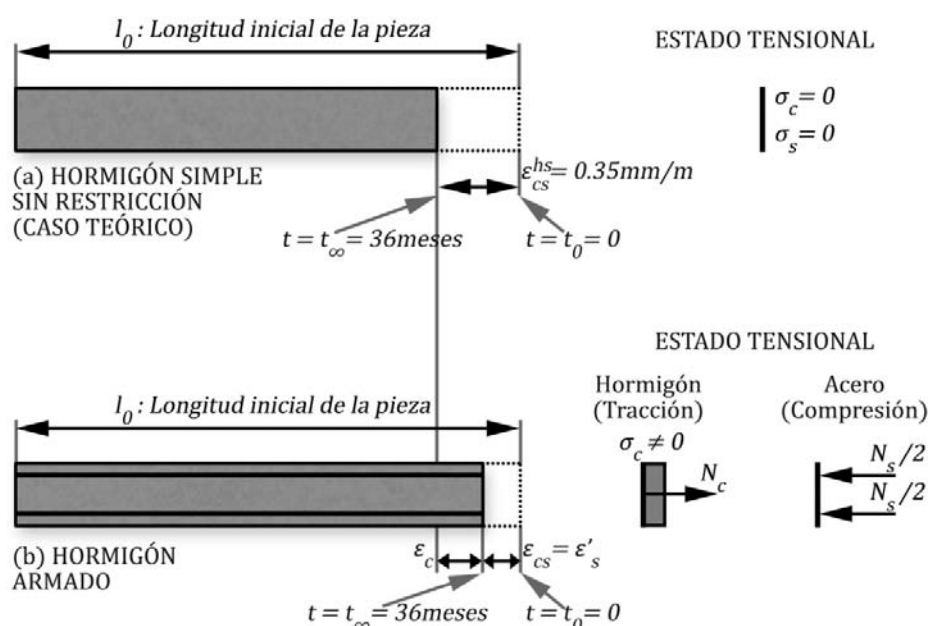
Efecto de la retracción en piezas de hormigón simple y armado
